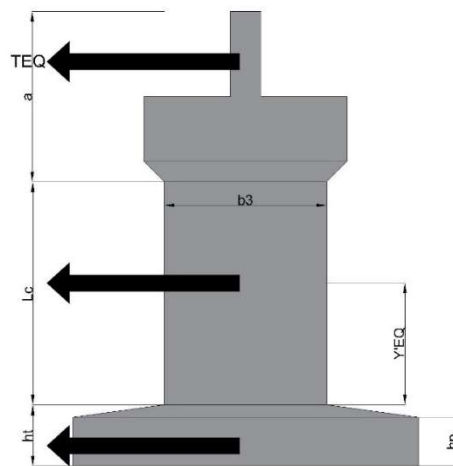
Notasi Beban Angin pada Pilar Arah Memanjang Jembatan
